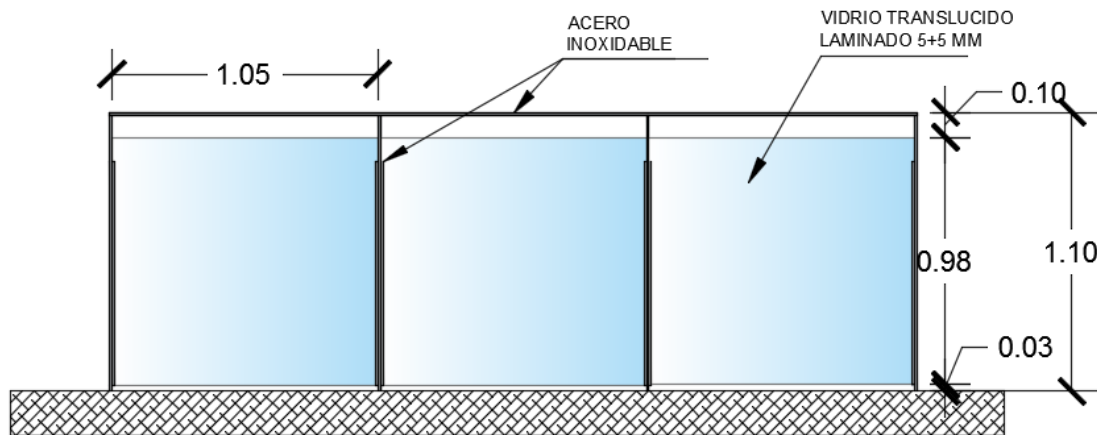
Detalle de la barandilla de vidrio translucido del apartamento. Fuente: Elaboración propia.
